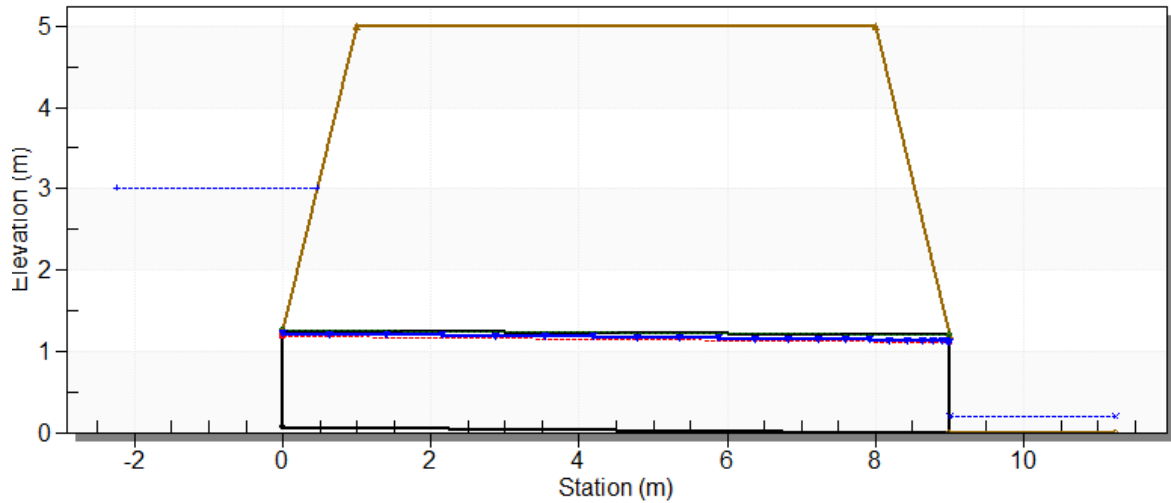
Desing Culvert. Concreto Reforzado 1200 mm
